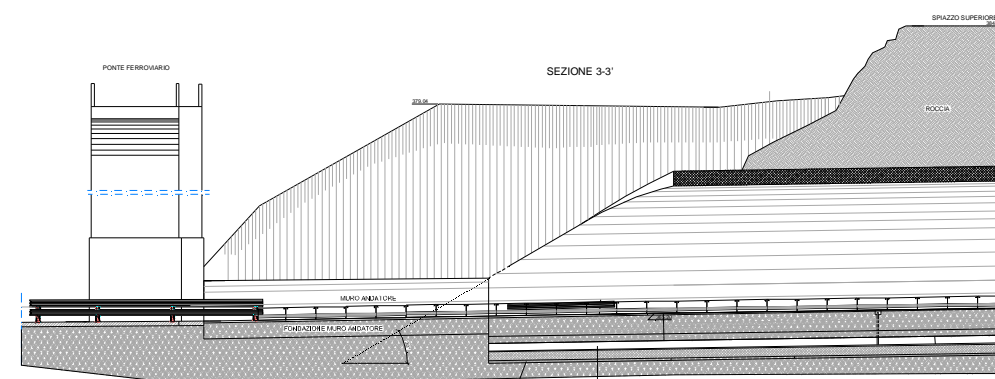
Sezione longitudinale - imbocco lato Solofra
